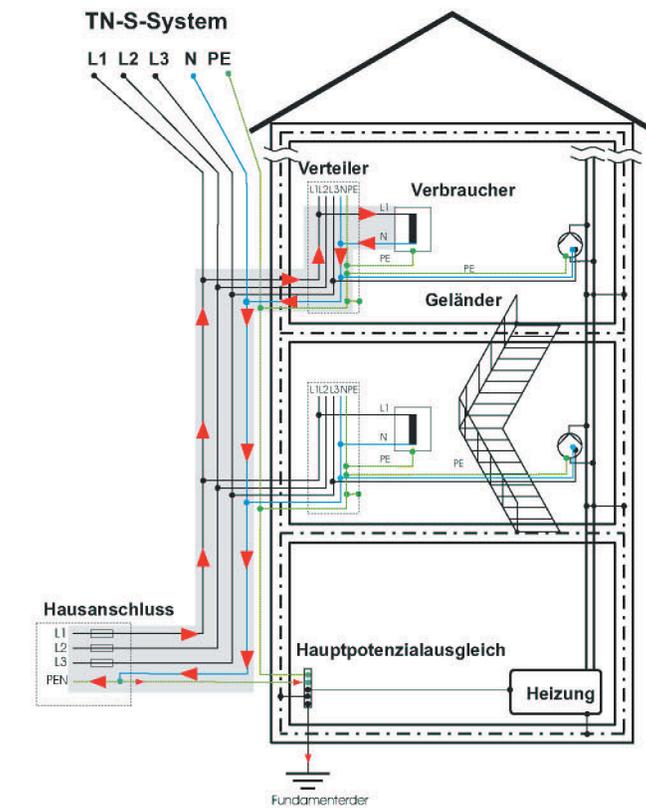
Stromverlauf der Betriebsströme in einem Gebäude mit Installation nach dem TN-S-System
